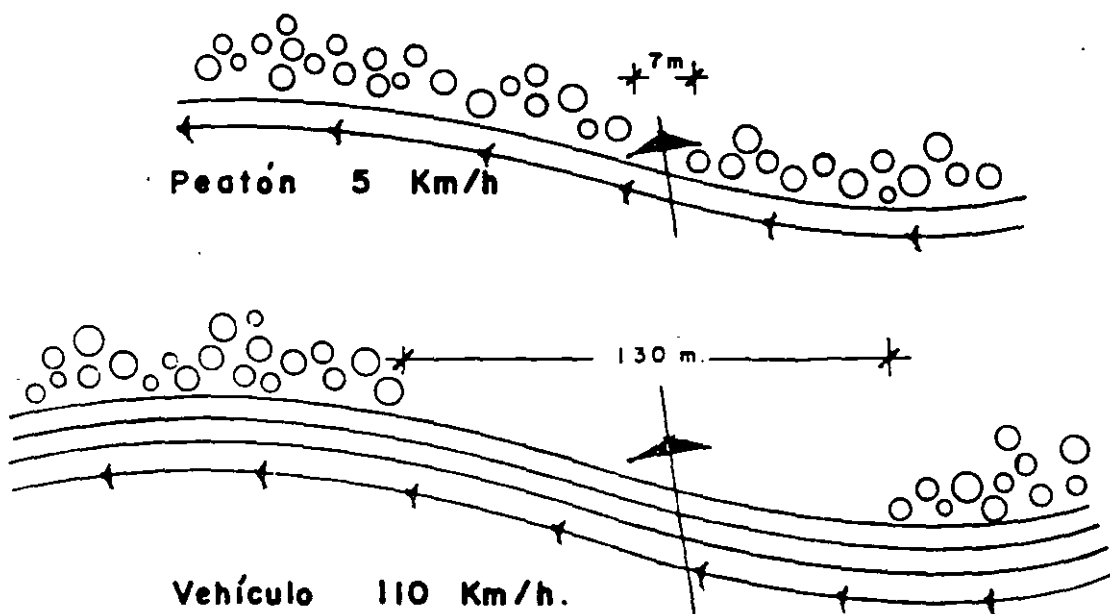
CAPTACION DE UNA VISTA EN UN INTERVALO DE 5 SEG.
